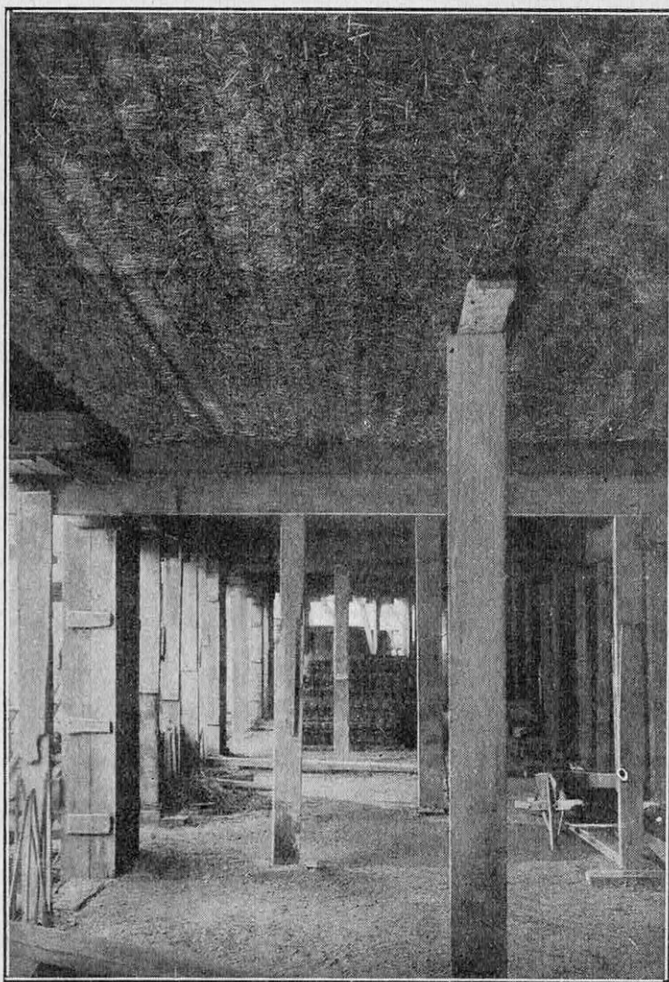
VUE D'UN PLAFOND DE L'IMMEUBLE DE RAPPORT MODERNE EN VOIE D'ACHÈVEMENT
